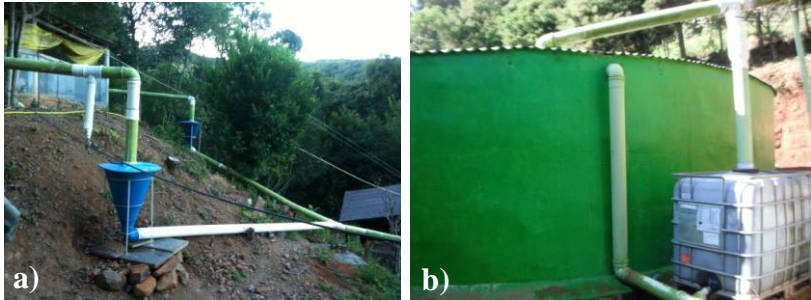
a) camada estrutural; b) vista geral do reservatório.
